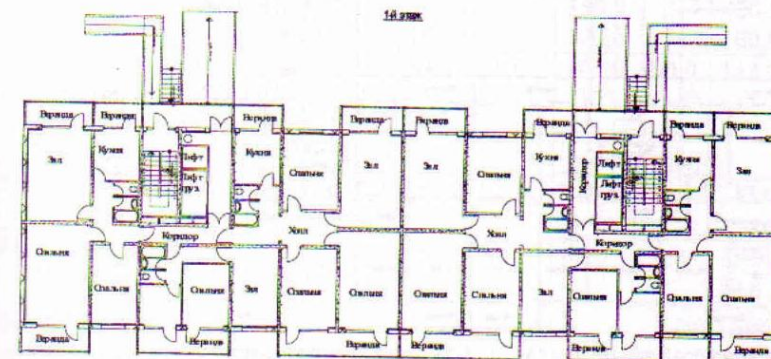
Двухсекционный жилой дом (2-3-4)+(2-3-4) комнатными квартирами. План 1-го этажа
